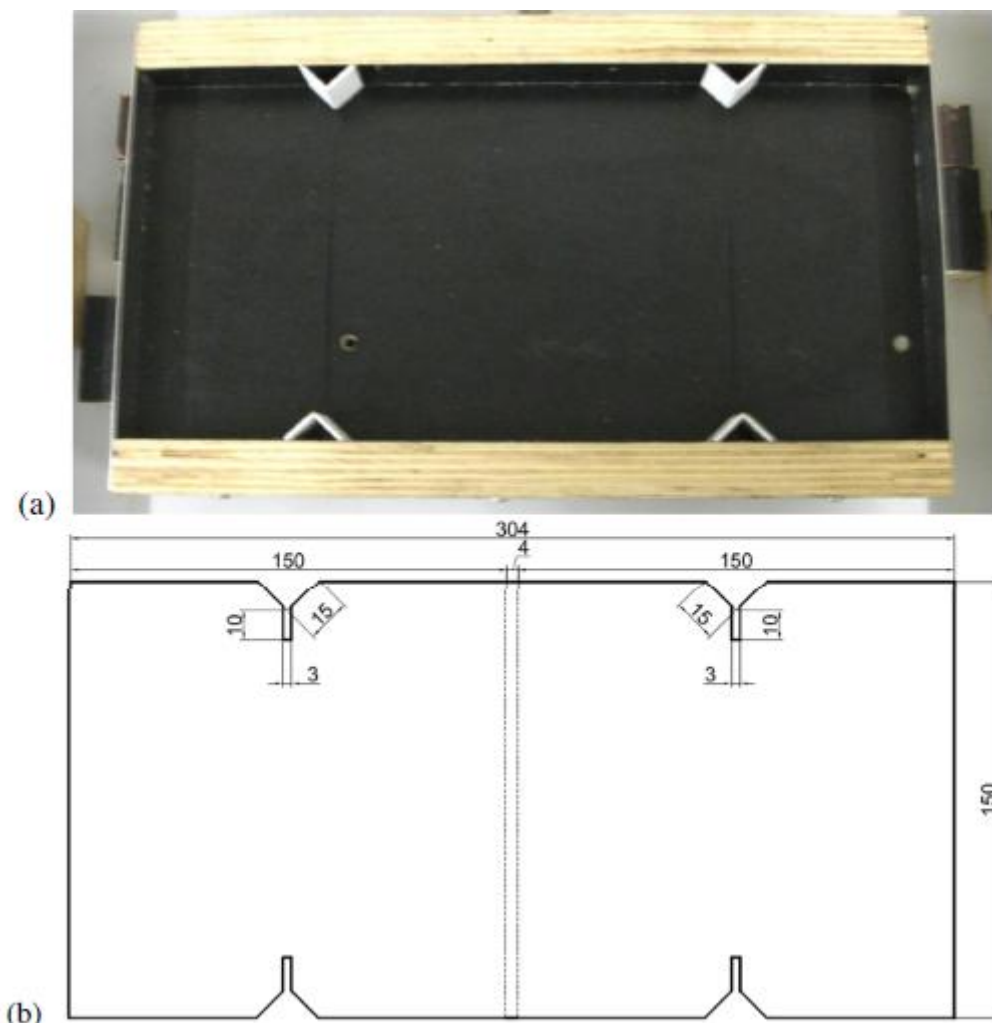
Molde utilizado para a betonagem (a); dimensões da placa que vai ser ensaiada (b)
